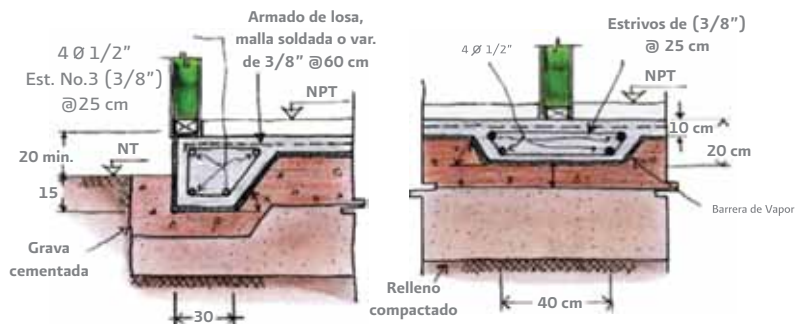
Cimentación con zapata corrida integrada a losa de concreto.
